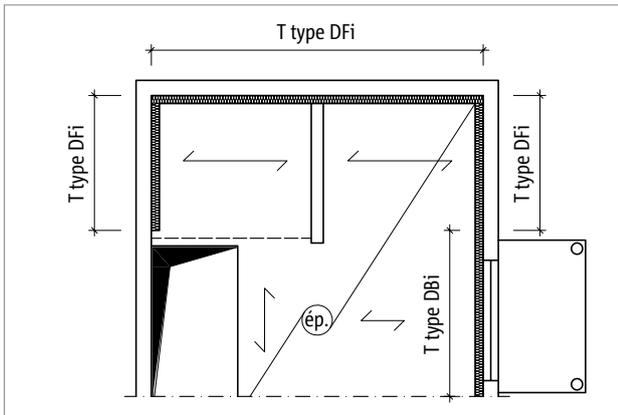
Schöck Rutherma® T type DFi : utilisation entre la dalle et la façade
